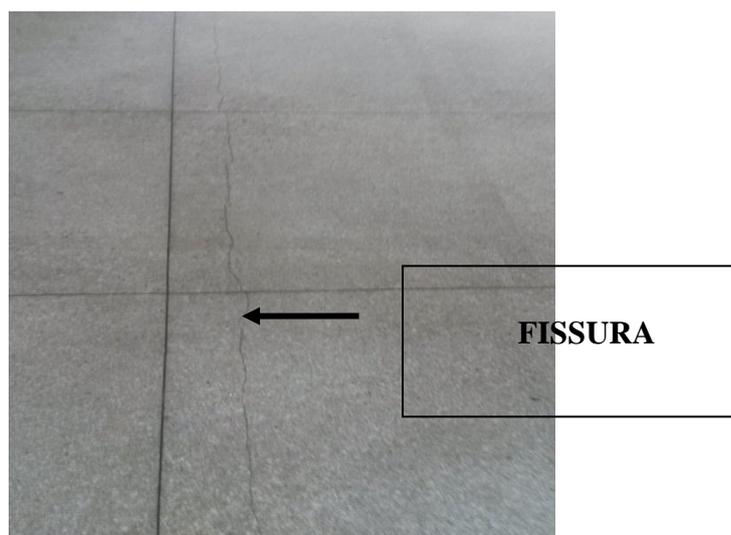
Laje com fissura na pavimentação - Fonte: O autor
